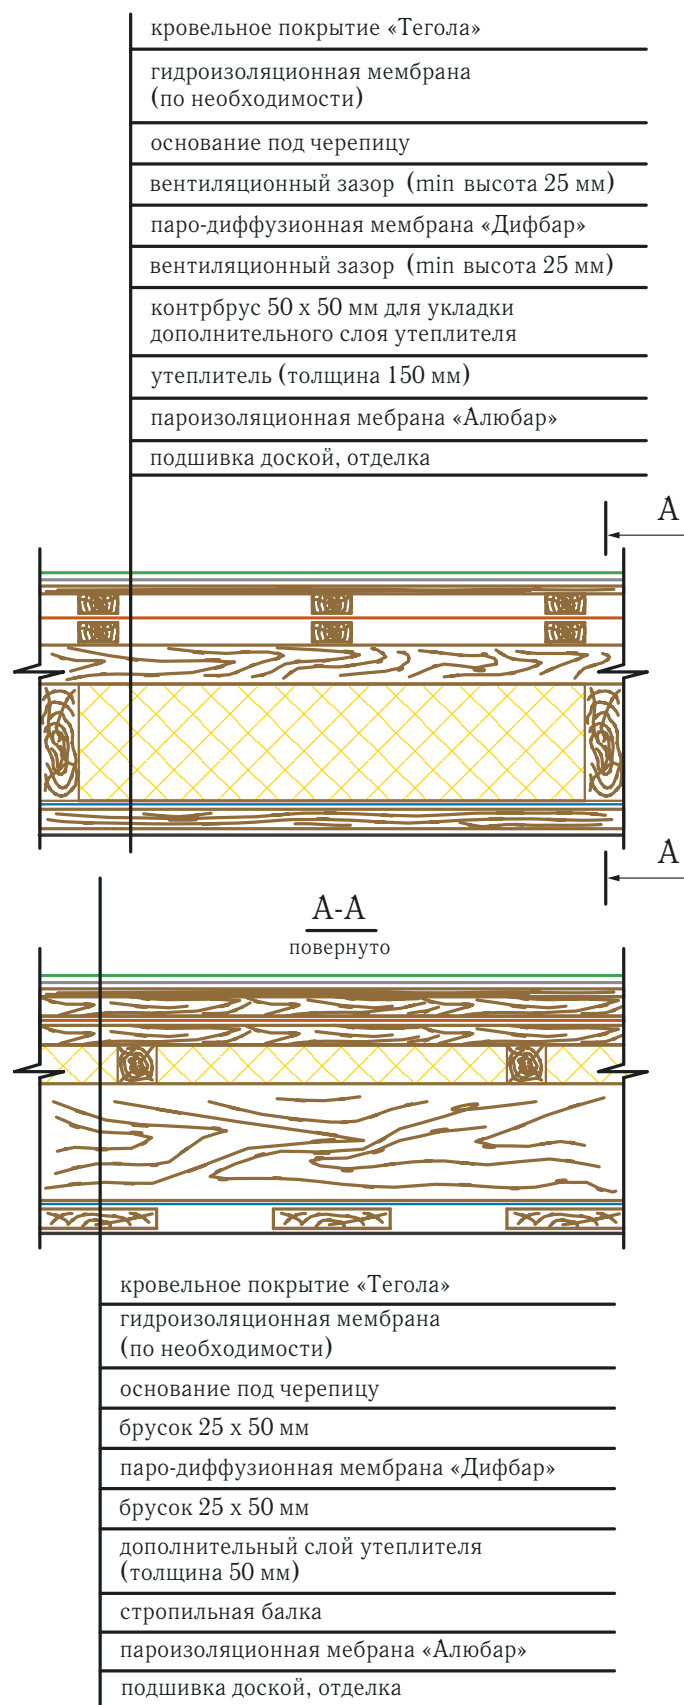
Кровельный пирог «жилой мансарды» с двойной вентиляционной камерой
